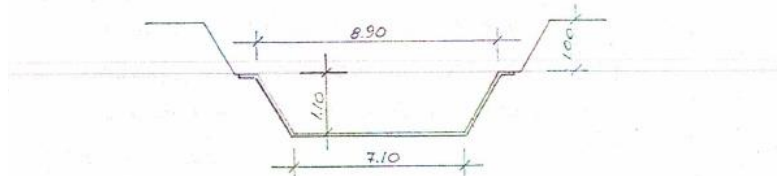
Sezione tipologica della sistemazione del Torrente Siede la cui geometria è stata utilizzata in alcune sezioni per modellare il fondo alveo
